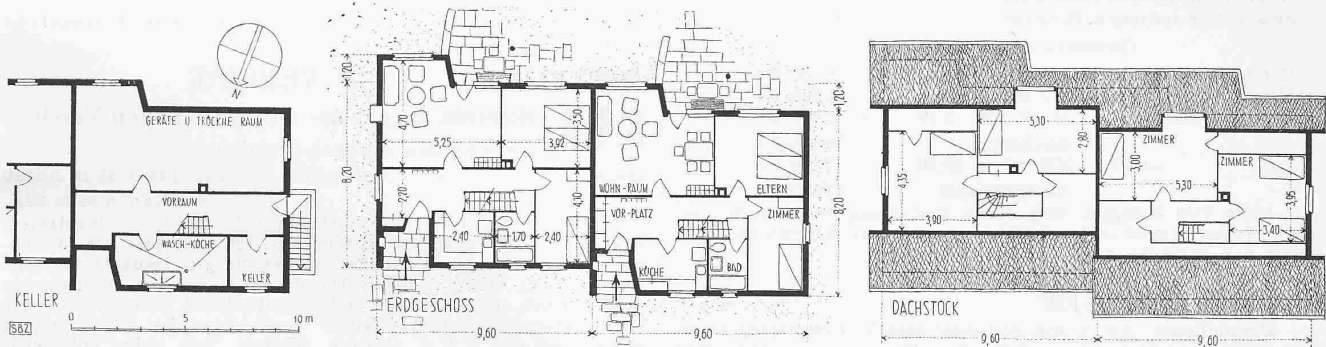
bis 5. Siedlung Wiesental, Kilchberg bei Zürich. Grundrisse Haustyp A, Masstab 1 : 300
